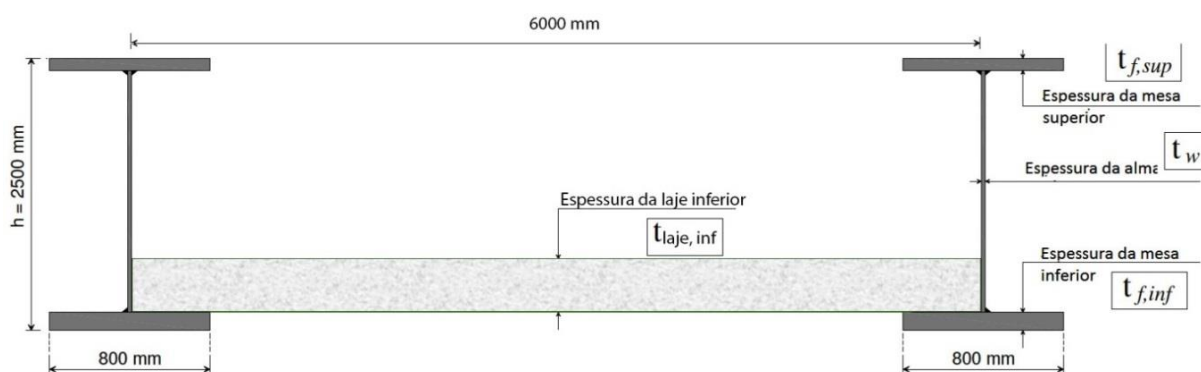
Características geométricas das vigas metálicas e laje inferior
